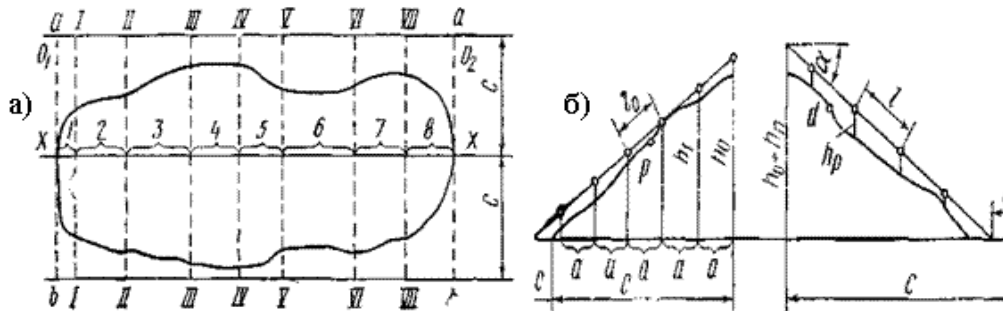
Схема розташування на штабелі: а – розріз (вид зверху); б – перетинів (вид збоку)
